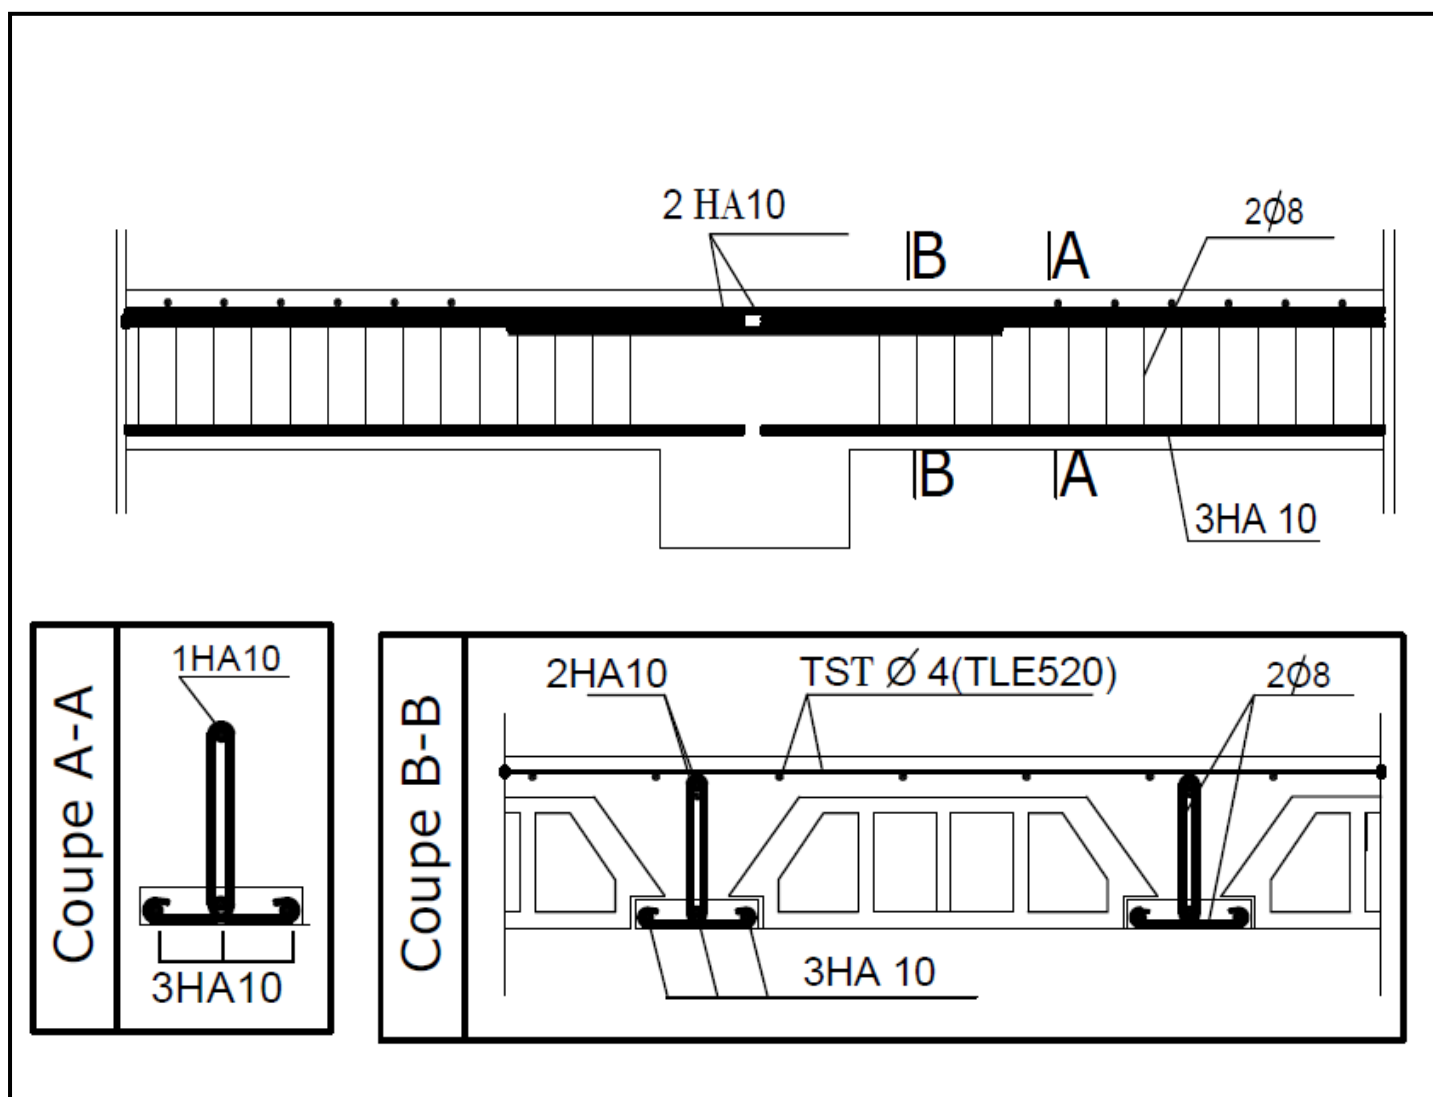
Plan de ferrailage du plancher en corps creux.
